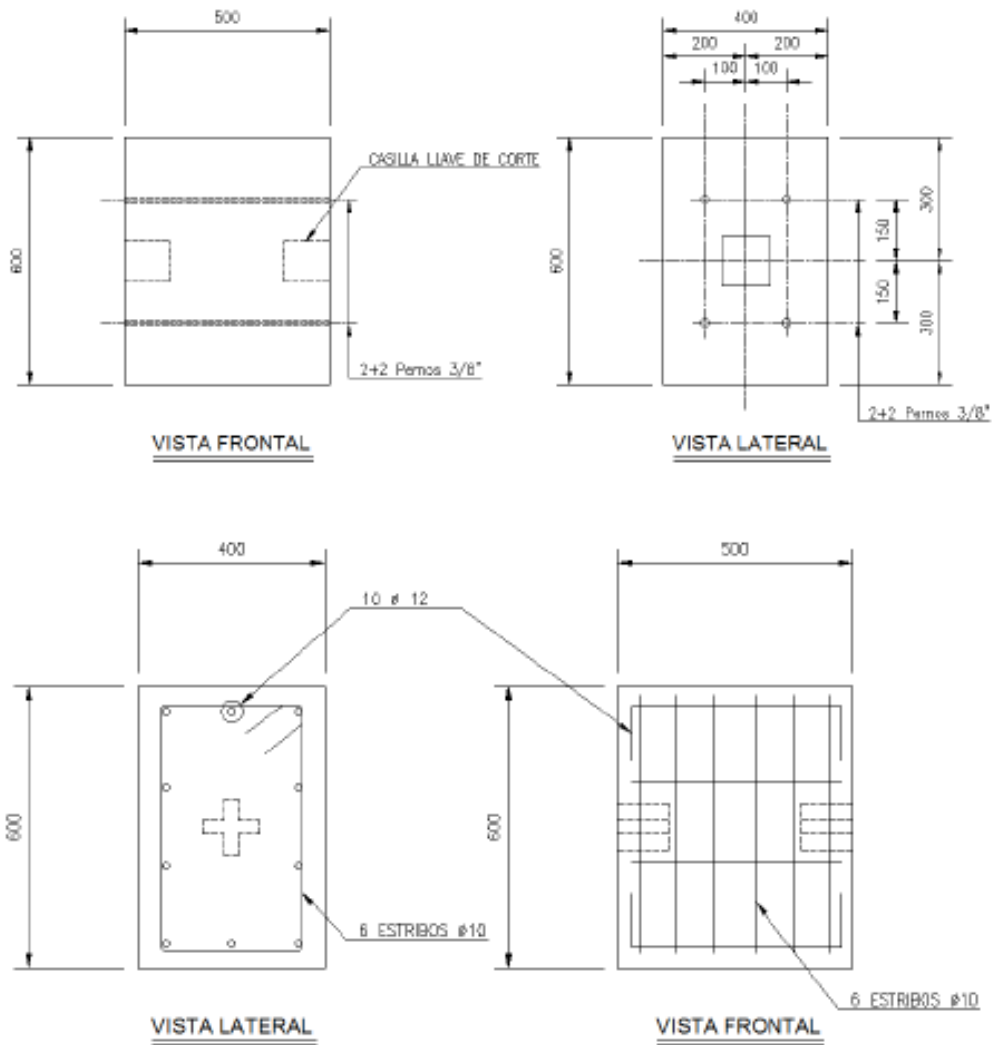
Dimensiones bloque de hormigón (Villar, 2013)
